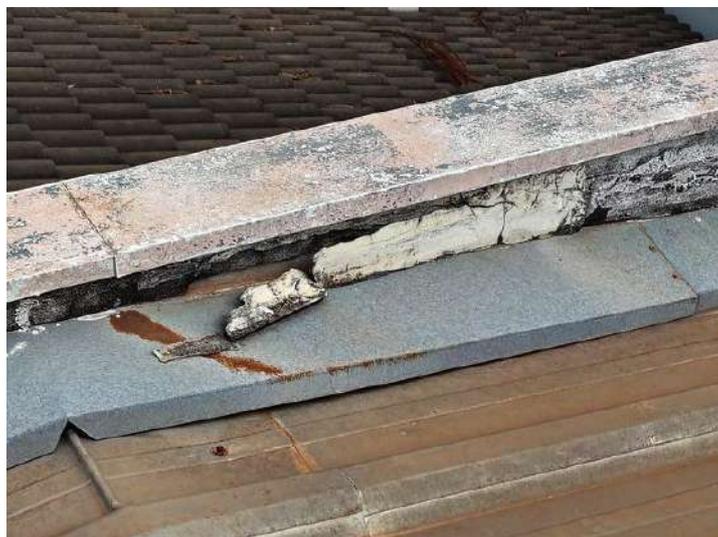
Cobertura Auditório – Descolamentos de emboço das platibandas
